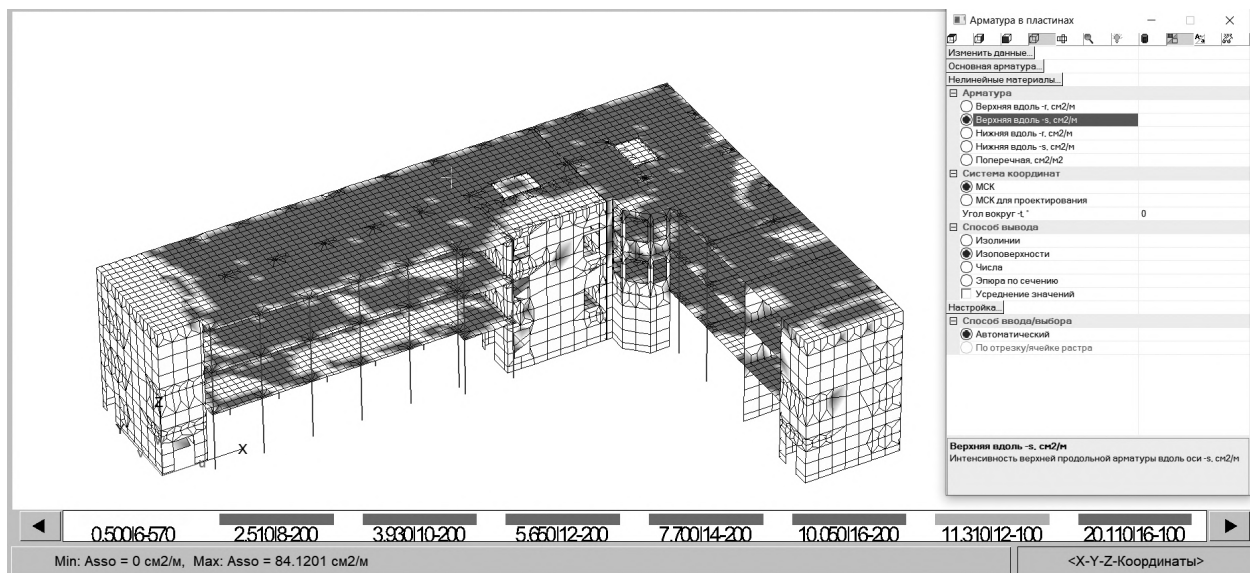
Изополя раскладки верхней арматуры плит перекрытия по оси Y
